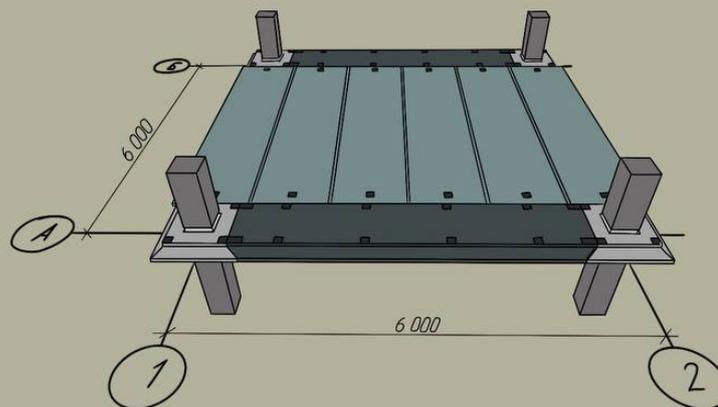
Схема монтажу пролітних плит
